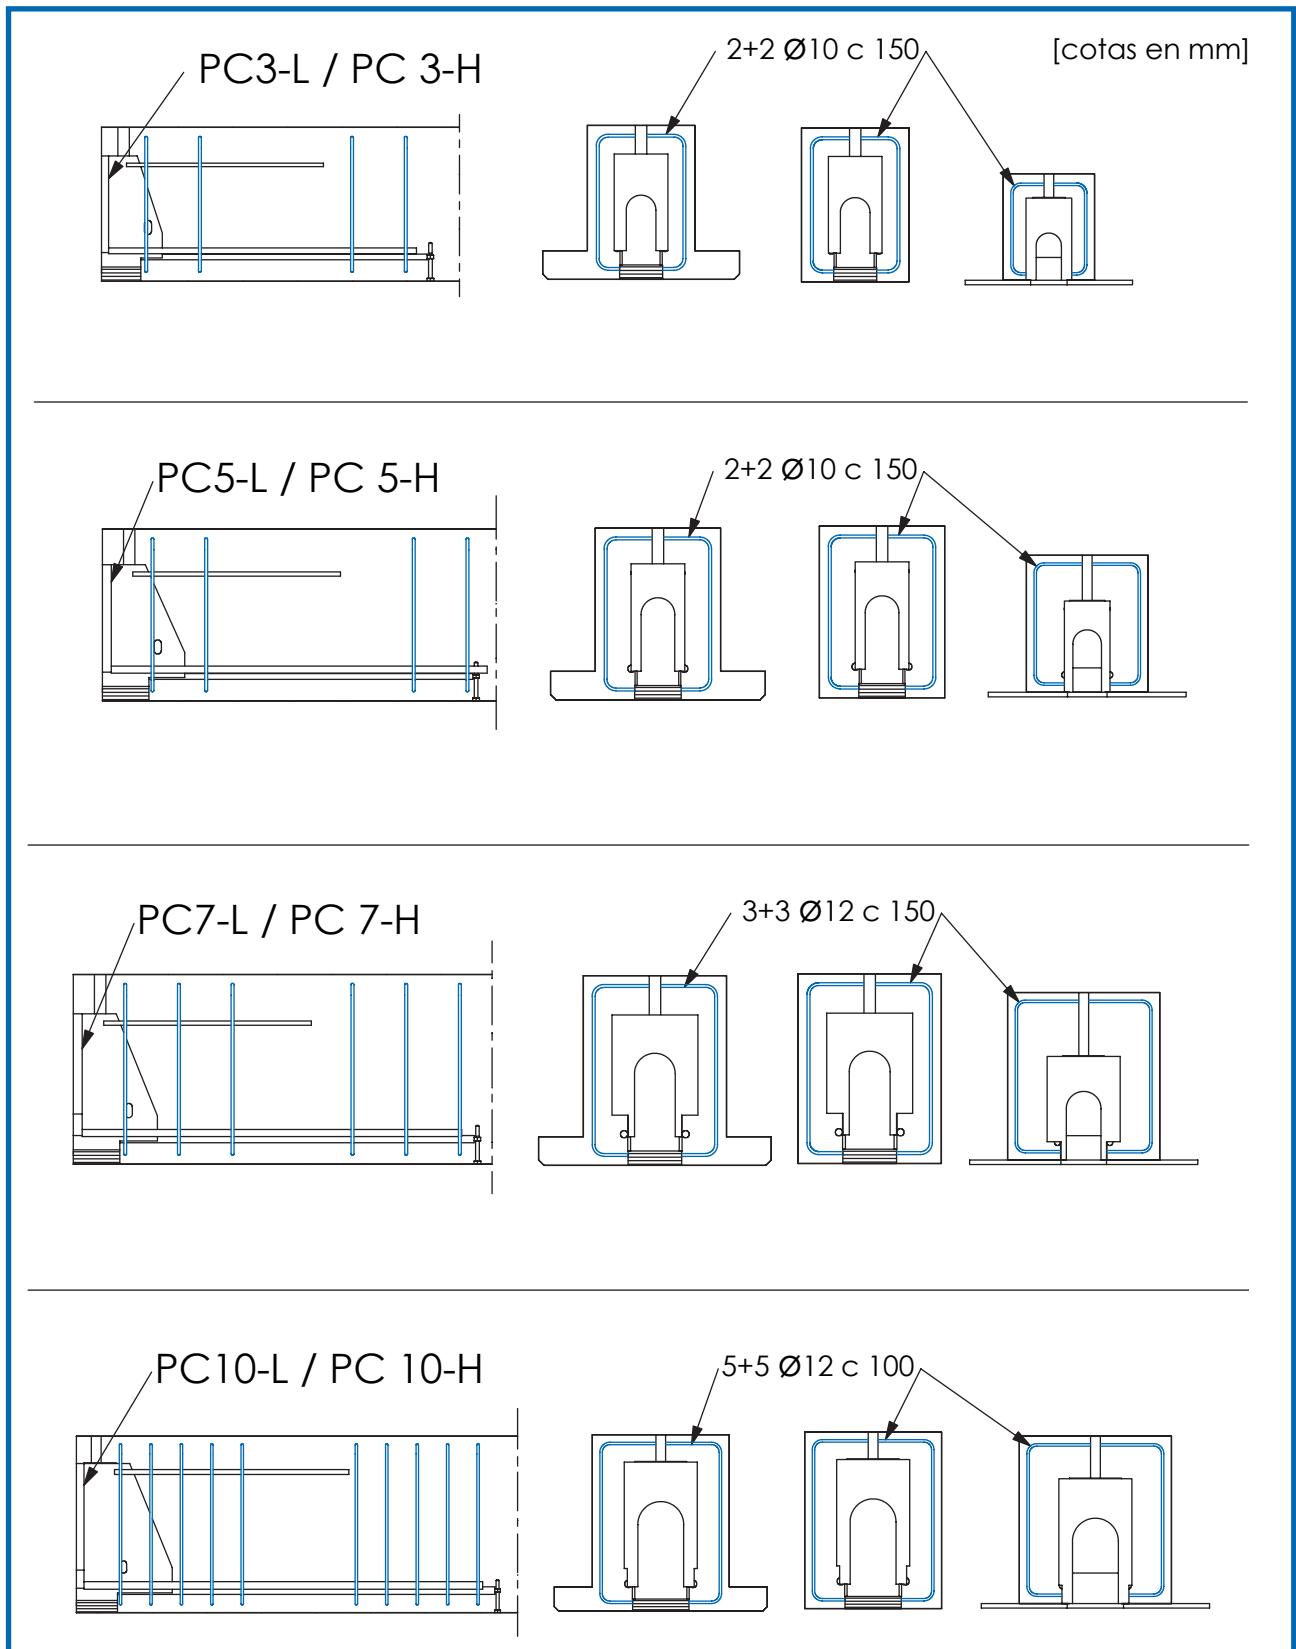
Ejemplos de colocación de los pies de viga PC y del tubo para el llenado de la junta en la armadura de las vigas.
